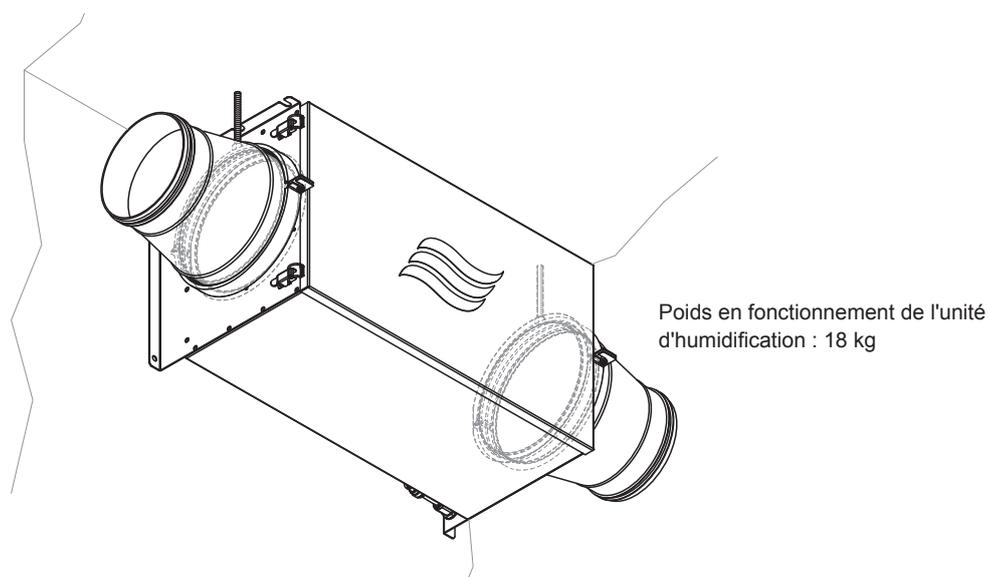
Fixez le kit de prémontage aux colliers de serrage
